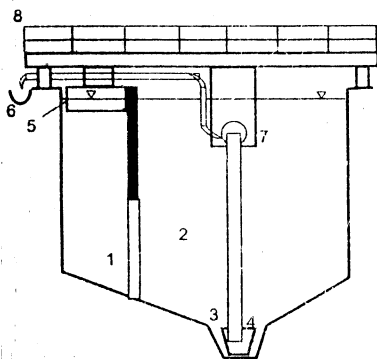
Deznisipator combinat cu separator de grăsimi:
